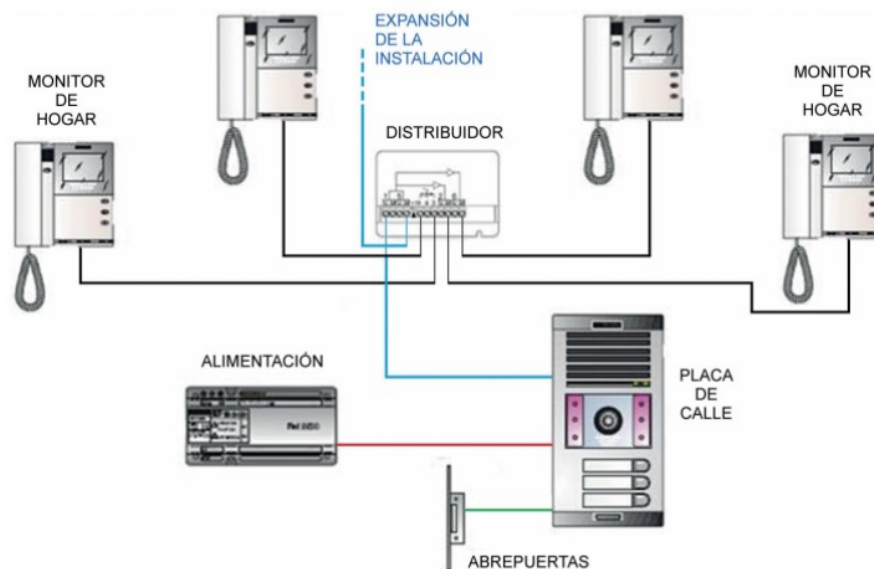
Instalación tipo de videoportero para una planta de 4 viviendas de un edificio [17]
